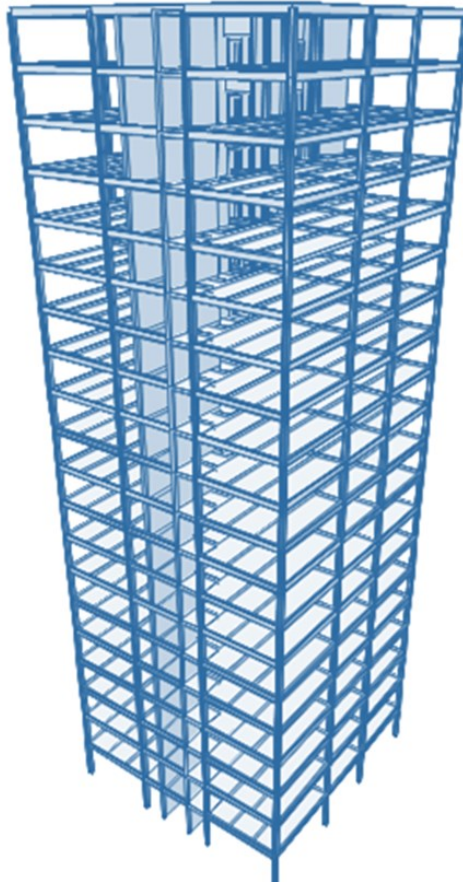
Vista 3D del modelo estructural en SAP2000.
